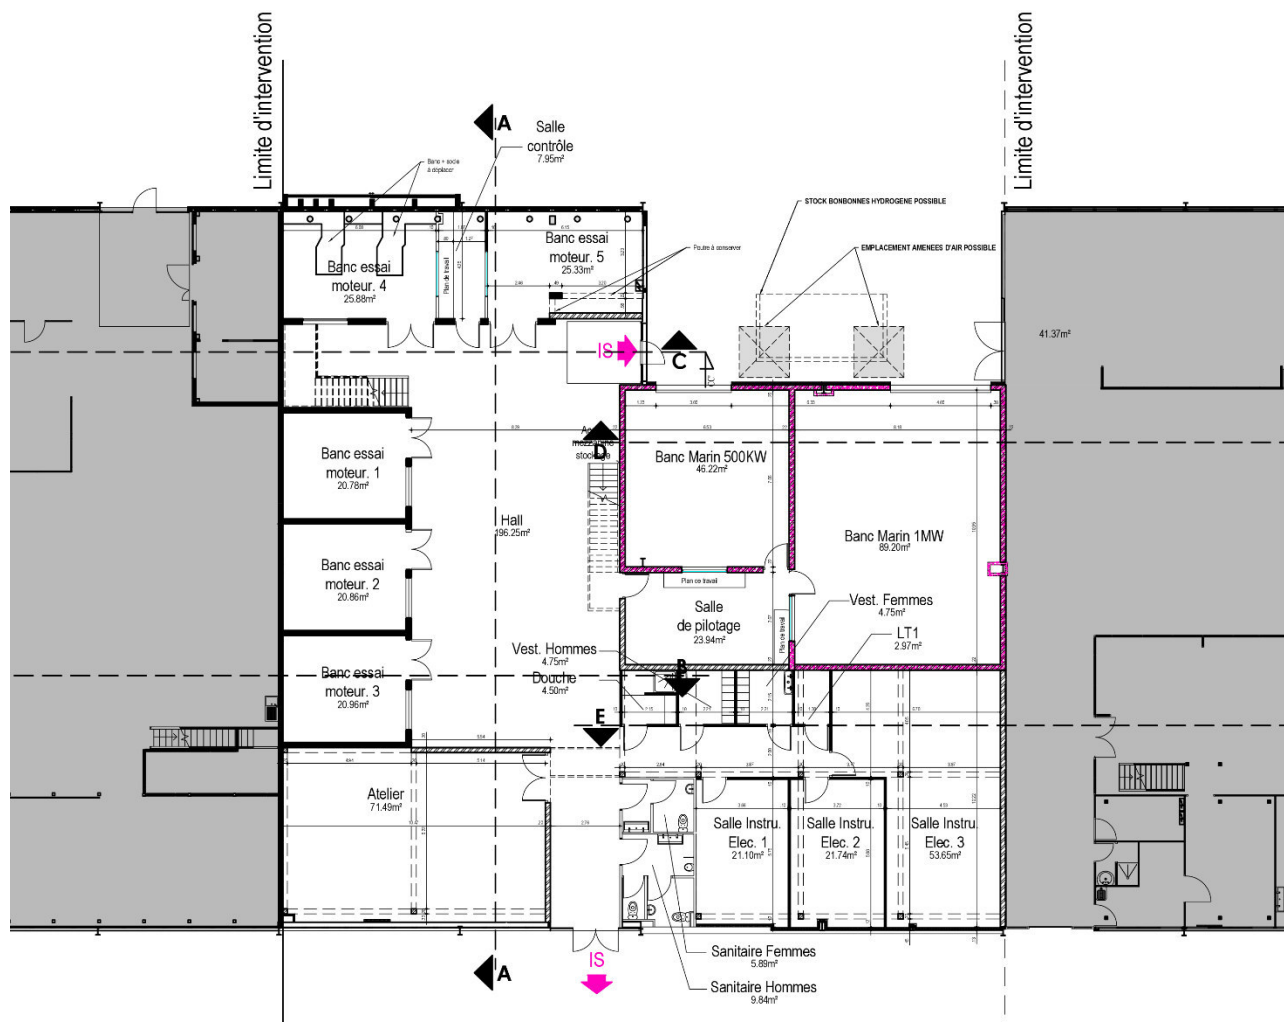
Plan de rez-de-chaussée des locaux en situation projetée
